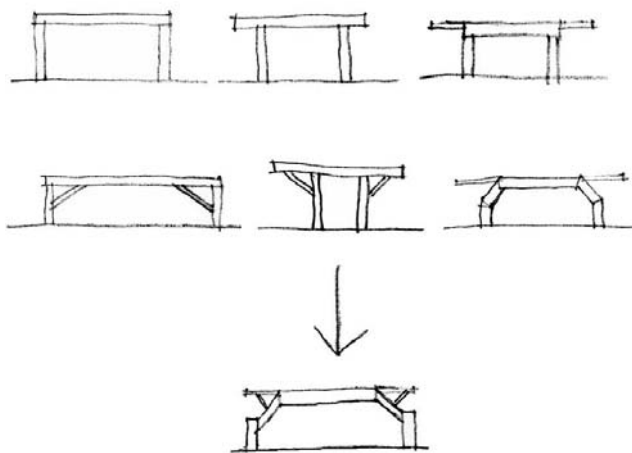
Schéma montrant l'exploration d'une relecture du système traditionnel poteau poutre comme démarche créative
